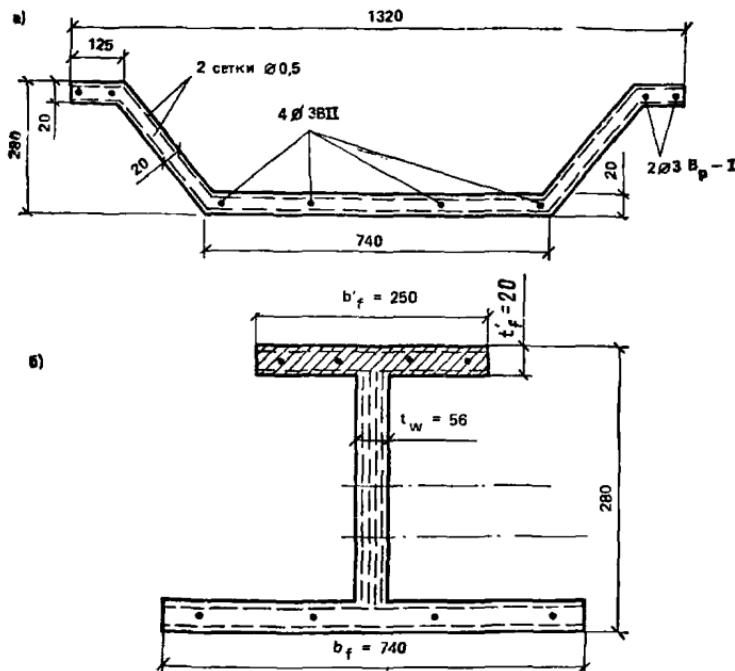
Сечения предварительно напряженной складчатой армоцементной панели покрытия
